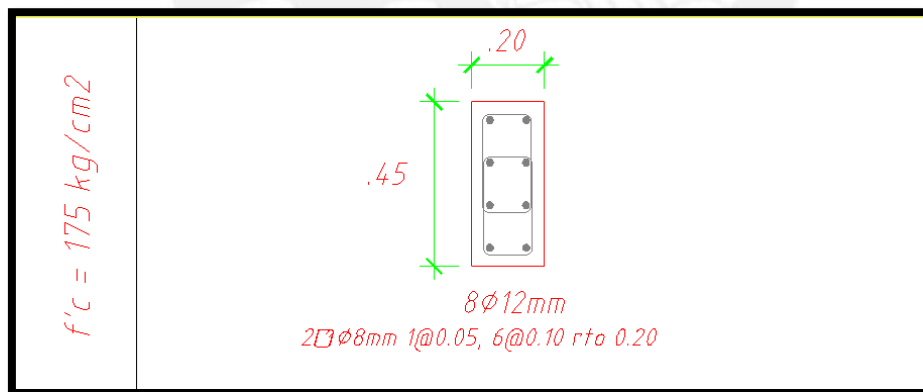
ARMADO FINAL PARA COLUMNA C-01
